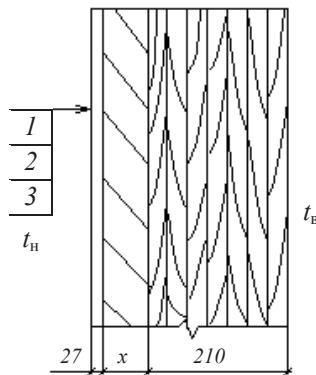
Конструкция стены из kleеного бруса с дополнительной теплоизоляцией:
